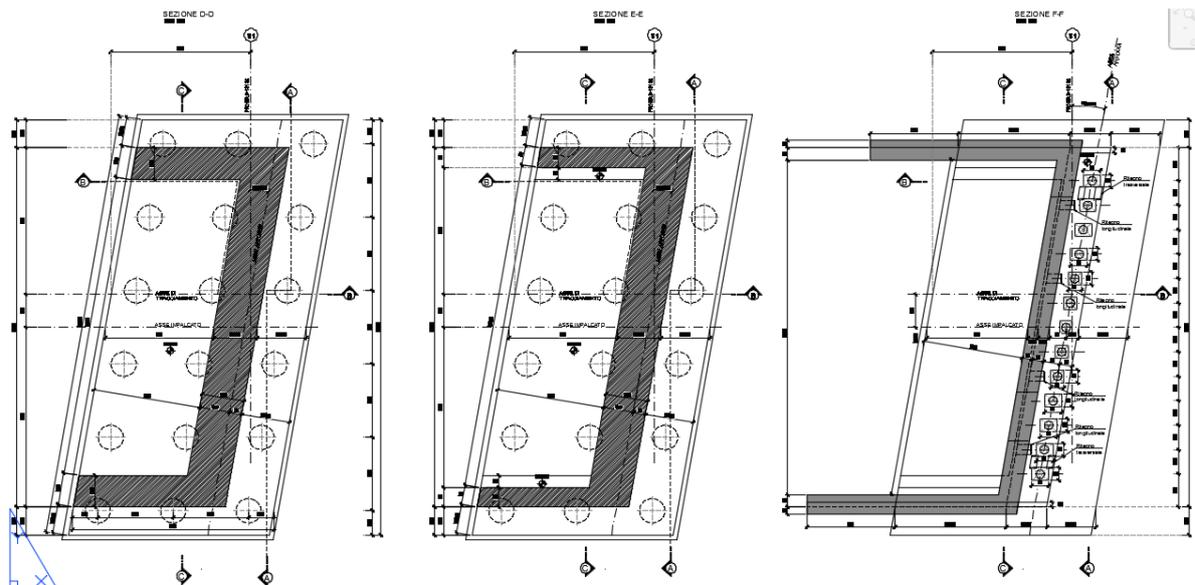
Sezioni longitudinale e trasversale spalla S1
